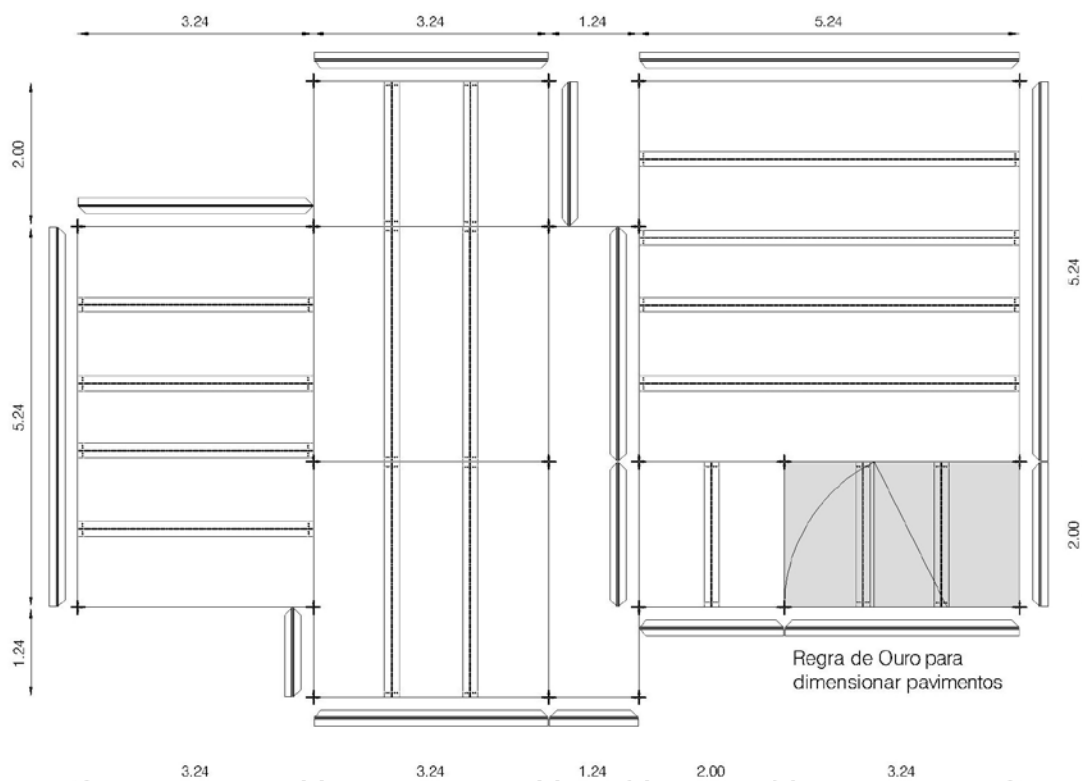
Organização de áreas de pavimentos e sua ligação com os pilares e vigas em forma de cruz grega e as madres em forma de T - vista em planta
